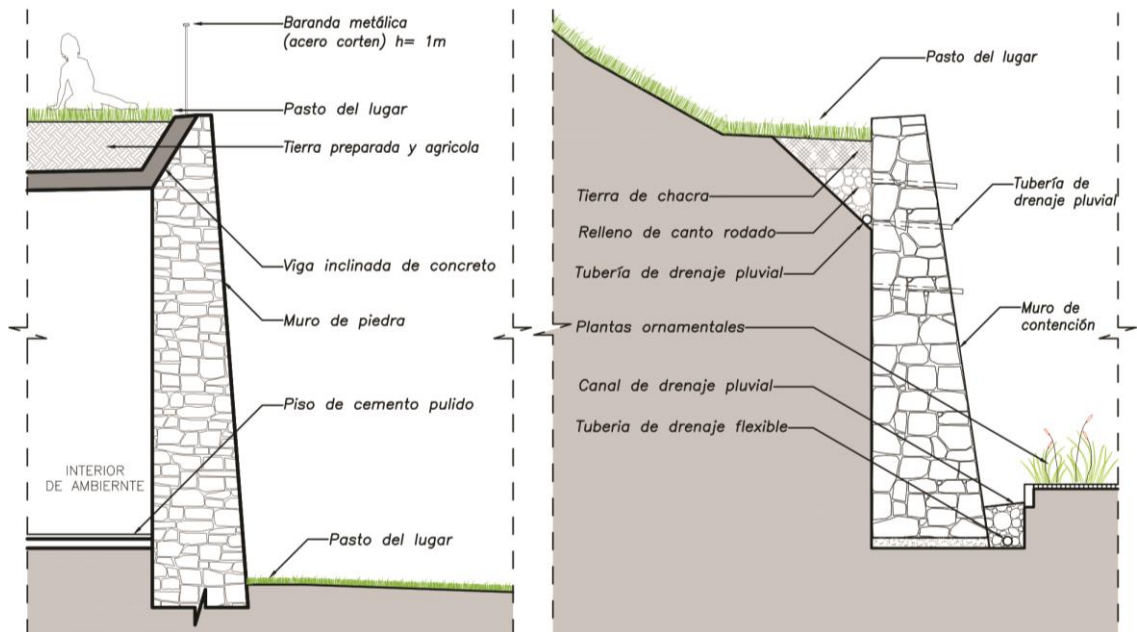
Sección constructiva del muro, (izquierda), sección constructiva de los muros de contención (derecha) Fuente: Elaboración propia
